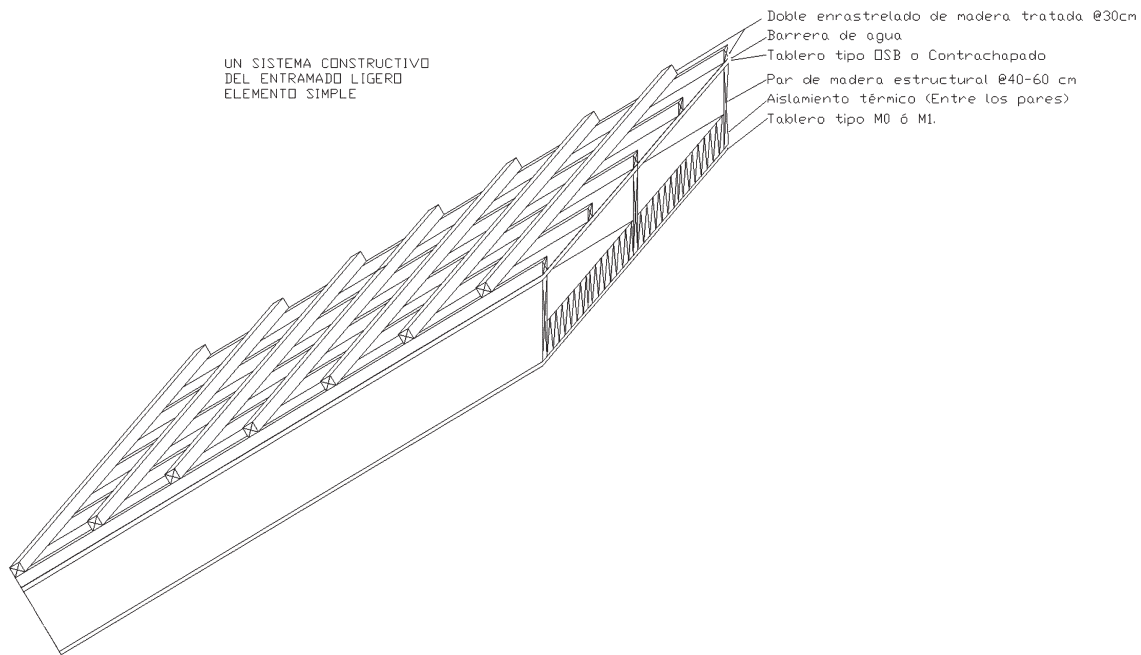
Ejemplo de sistema constructivo simple de entramado ligero.
